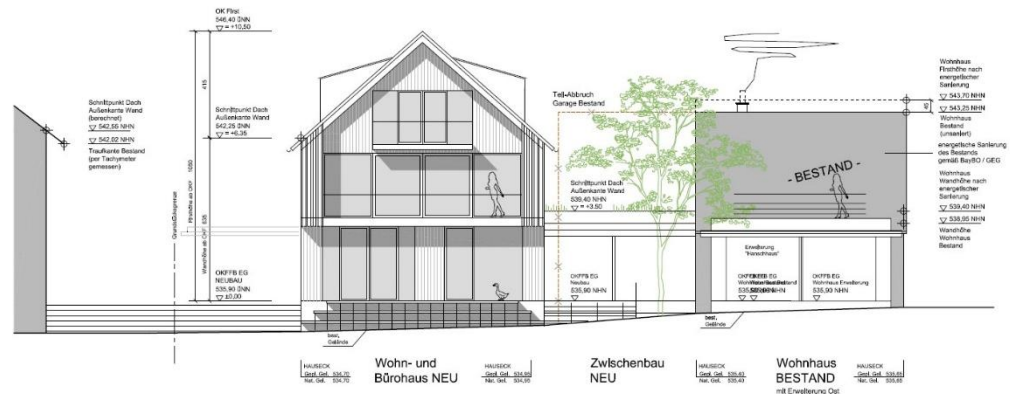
Bestehendes, vorderliegendes Gebäude, das für ein Stiftungsgebäude geplant ist. Quelle: Planungsverband, Stand Juni 2024
